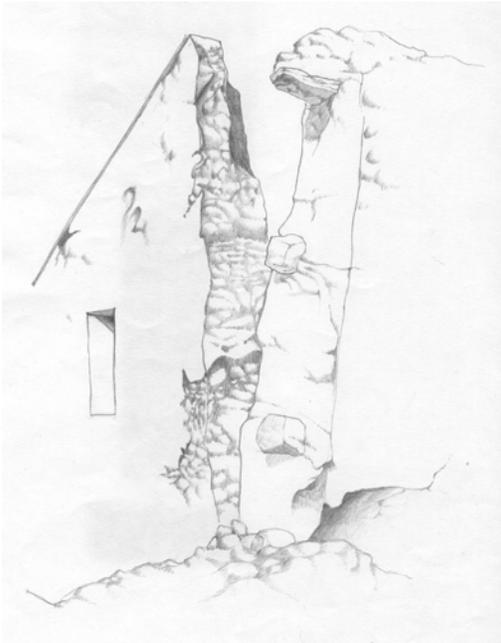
Fissuração de cunhal em Pias (Corte do Pinto)
